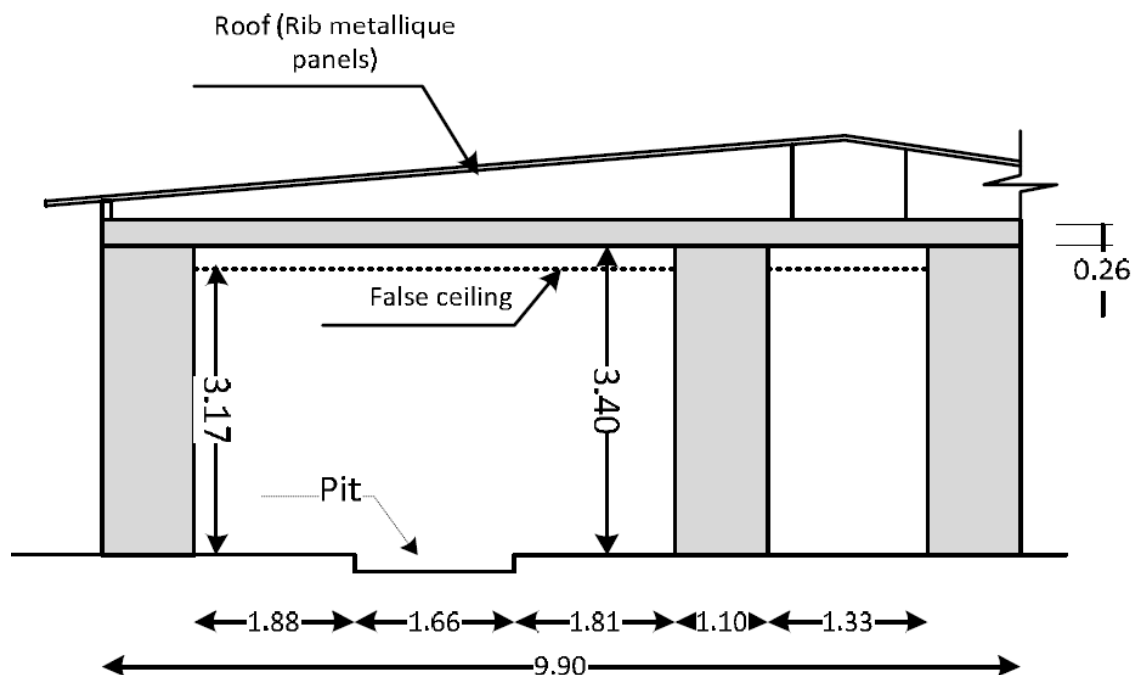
Plano de planta Bunker Hospital en Uganda [23].
